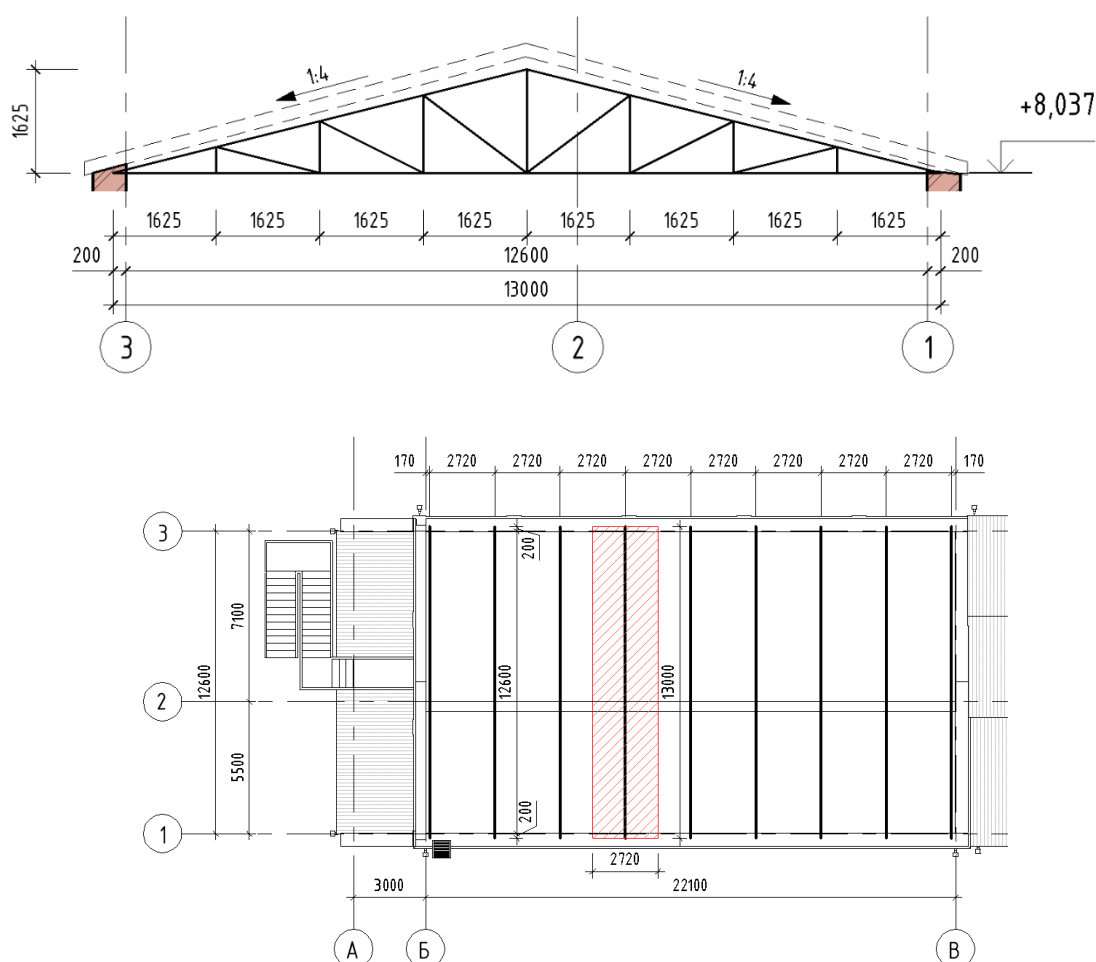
Данные о геометрии фермы для расчета и грузовая площадь
